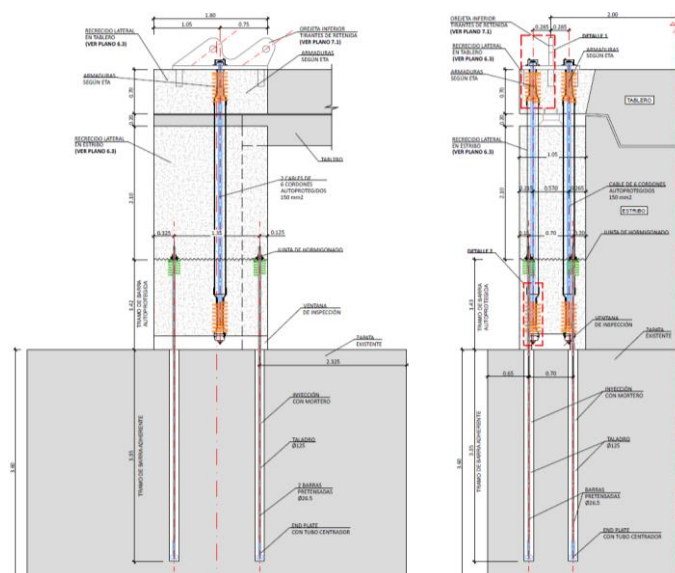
Alzado y sección de anclajes verticales en estribo móvil (E-1).
